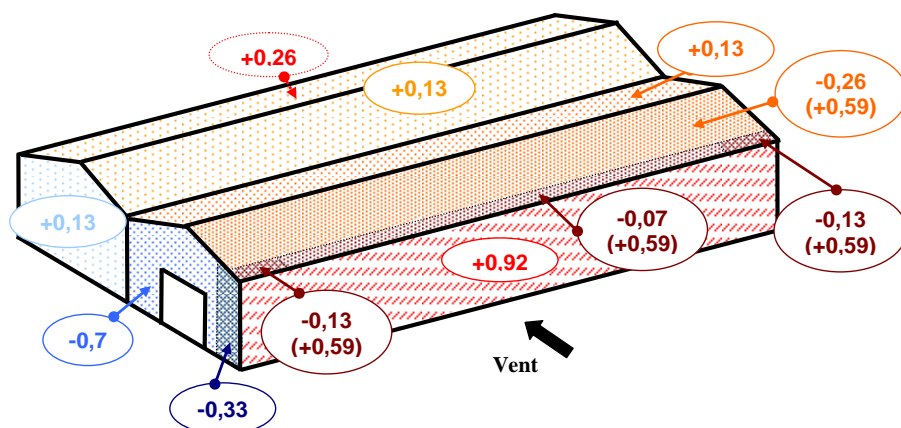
Situation de projet accidentelle : porte ouverte sous le vent (vent sur long-pan) avec $c_{pi} = -0,7$
